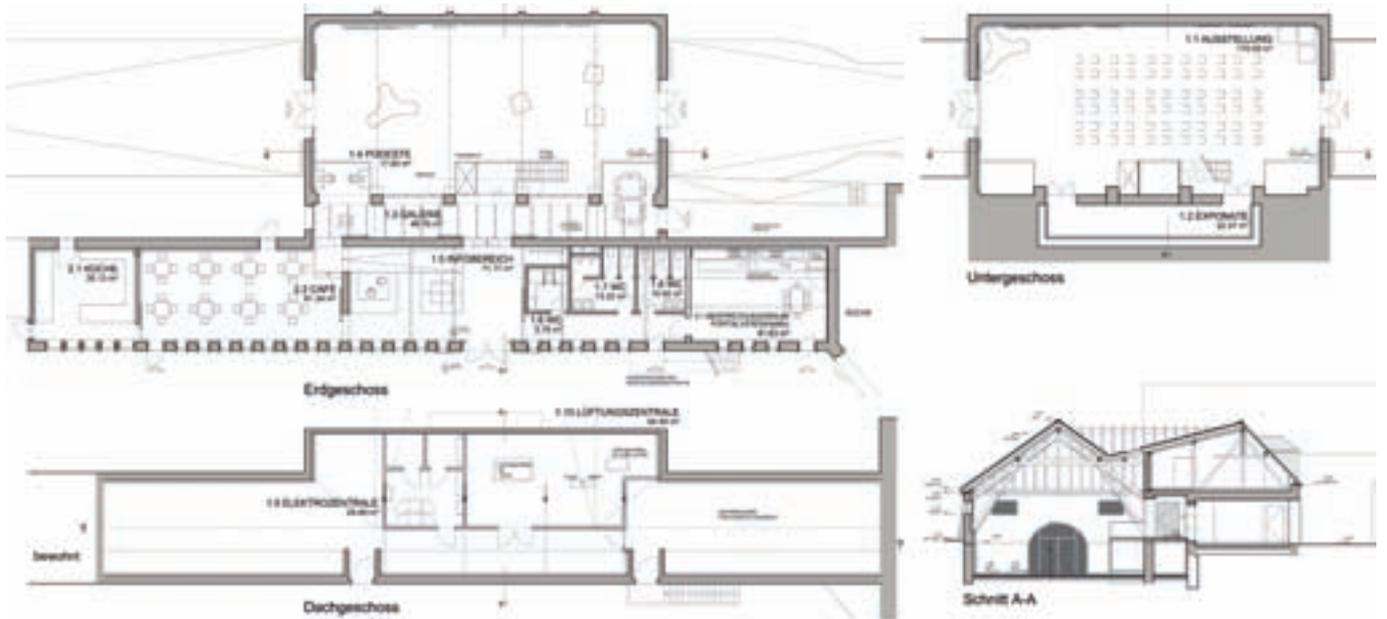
Grundrisse geplanter Ausbau Dach- und Erdgeschoss Gut Leidenhausen (luczak architekten)
